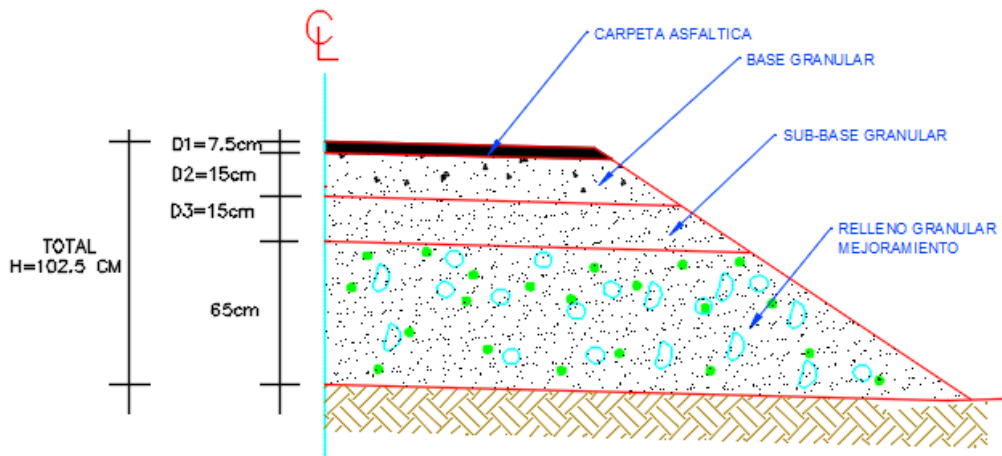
Paquete Estructural Obtenido sin Refuerzo de Geomalla
